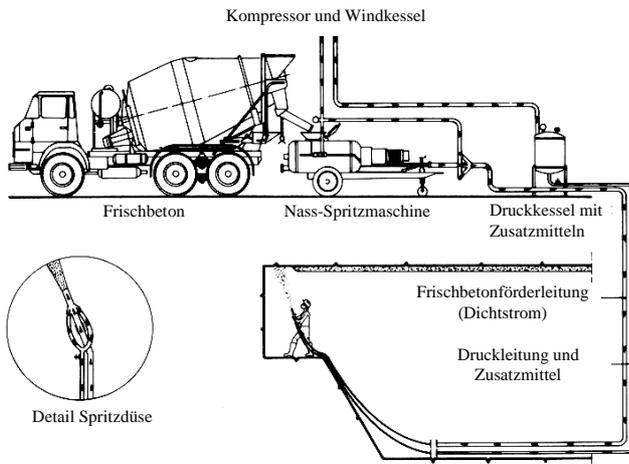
Verfahrenstechnik des Nassspritzverfahrens im Tunnelbau [1, 7]
